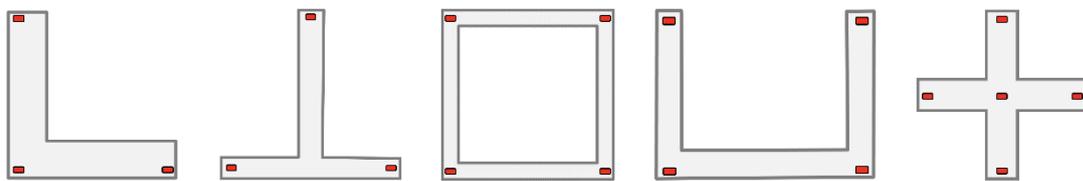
特殊平面形狀建築，建議感測器平面配置說明圖
